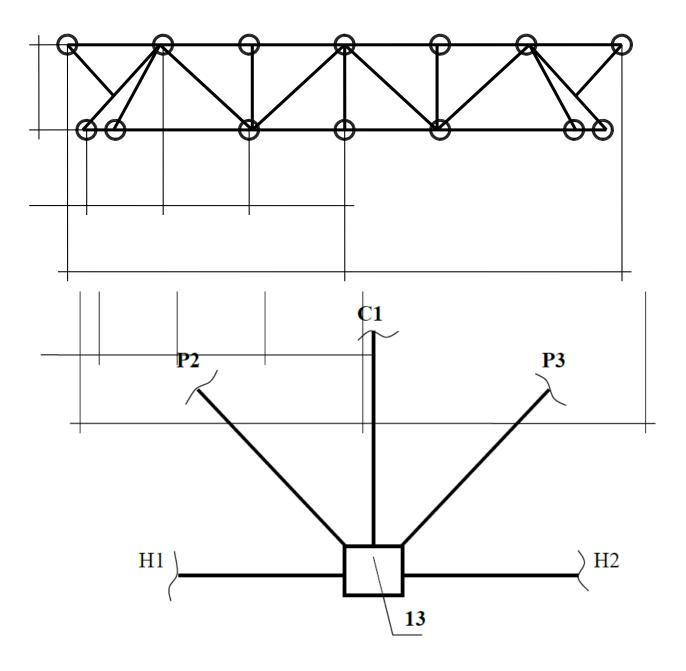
Геометрическая схема стальной фермы покрытия VI-ФС 18-4,40 и схема заданного узла фермы
